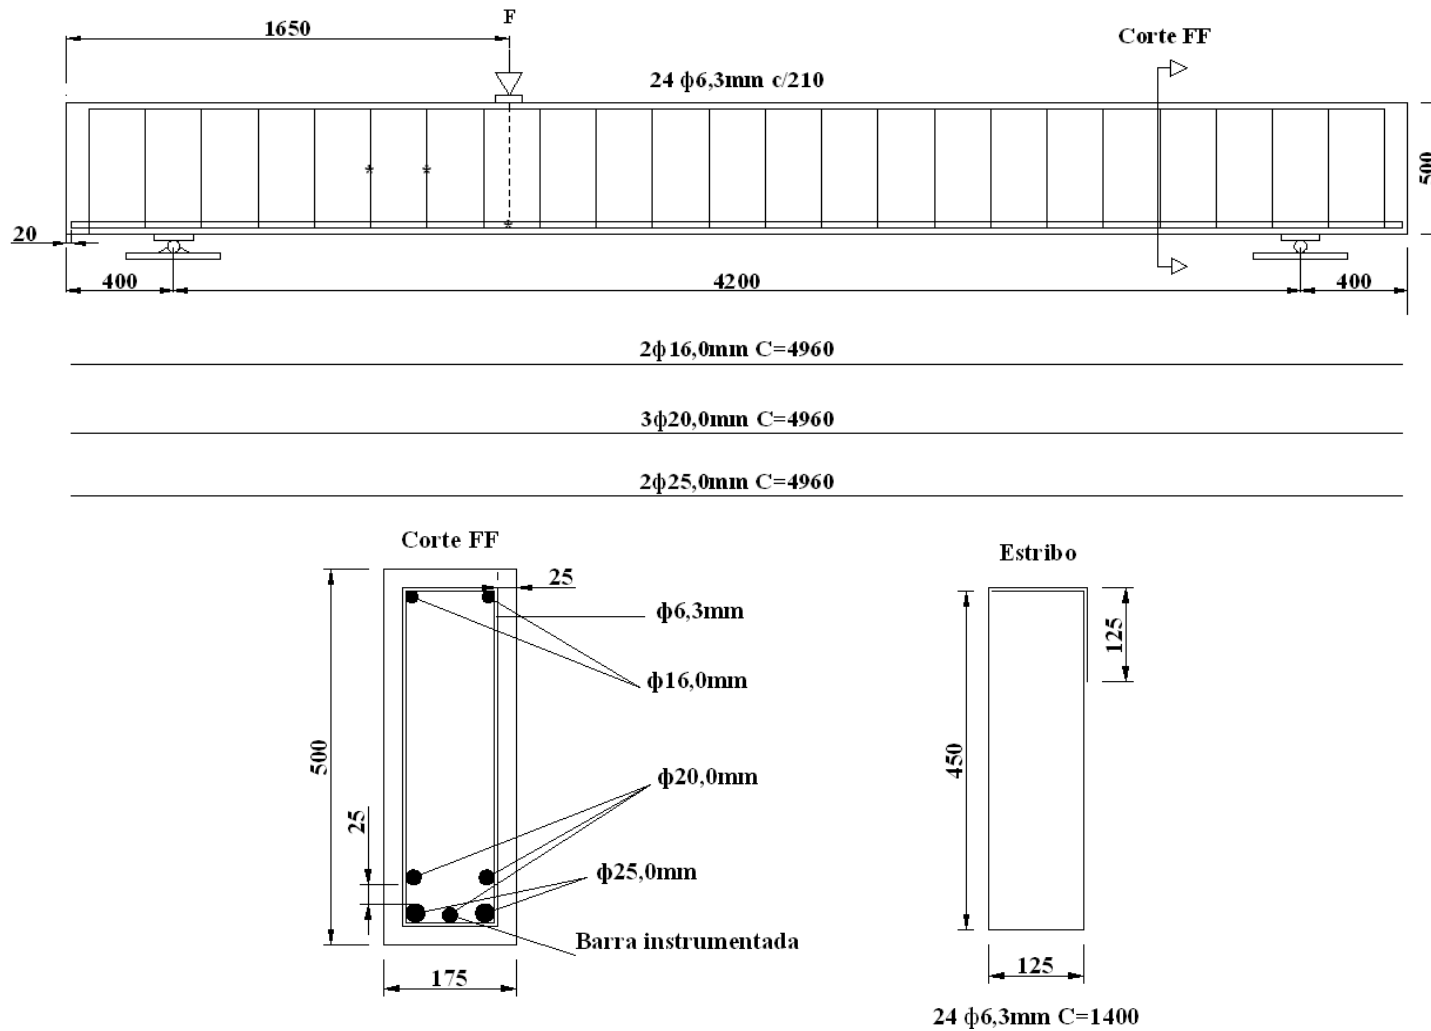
Armaduras e posicionamento dos extensômetros (\*) da viga V6 (dimensões em mm).
